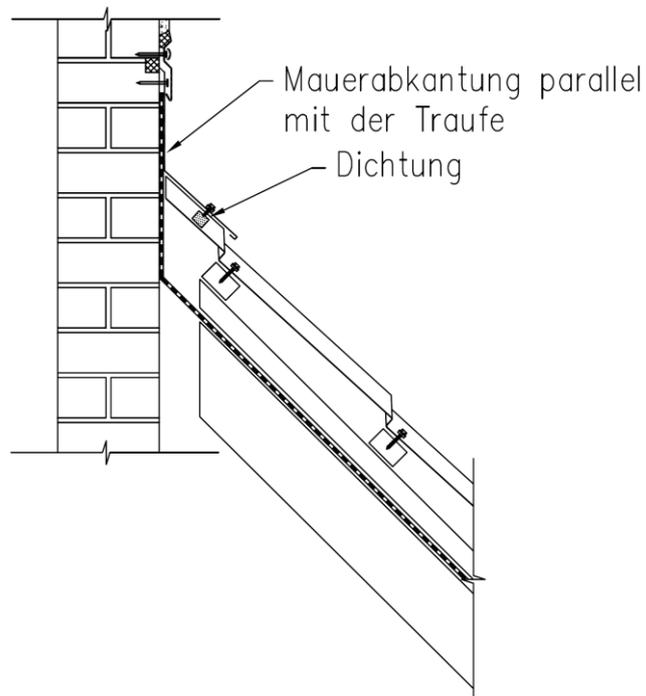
Beenden der Dachdeckung unter Wand parallel mit der Traufe
